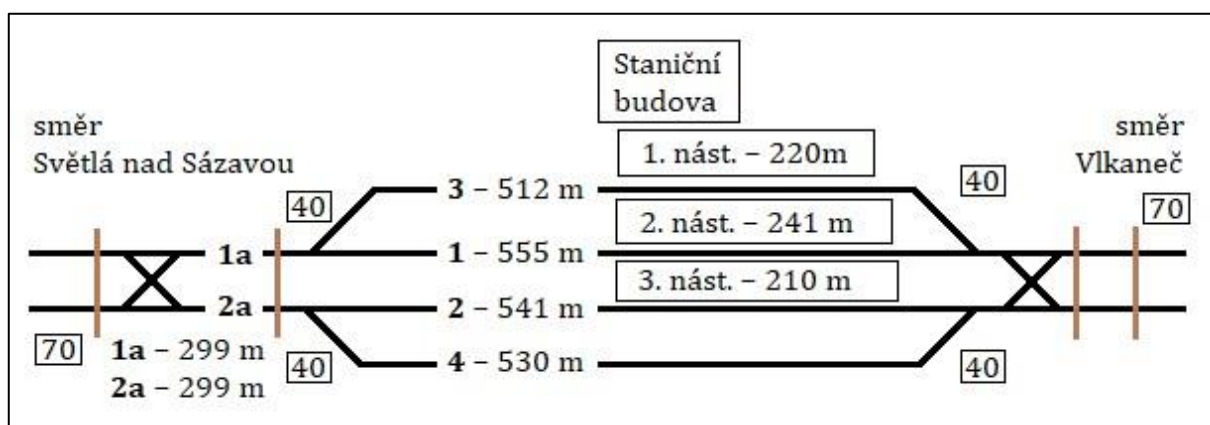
Zjednodušený plán stanice Světlá nad Sázavou Zdroj: (6, upraveno autorem)
